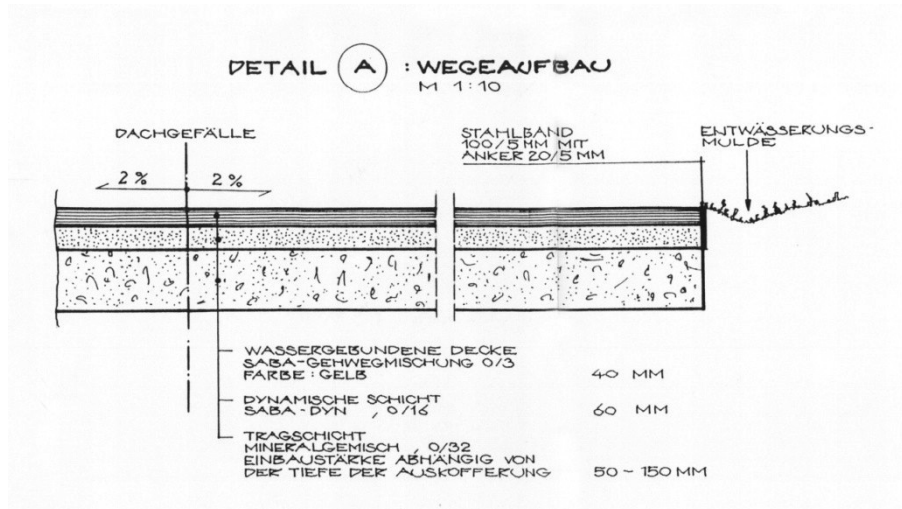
„A 20“, Ausschnitt Plan vom Wegeaufbau, 1998
